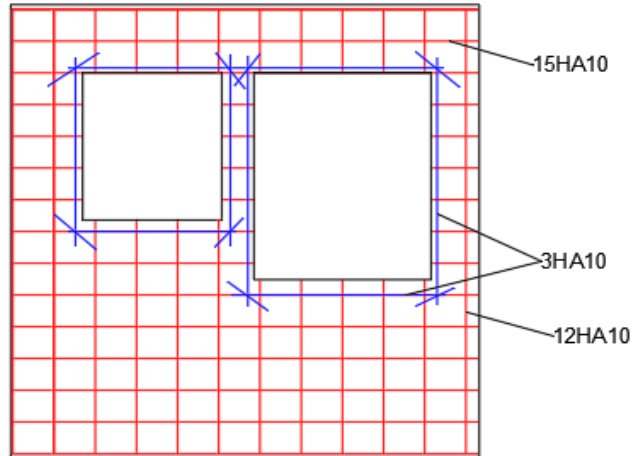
Schéma de ferrailage de la dalle pleine.
